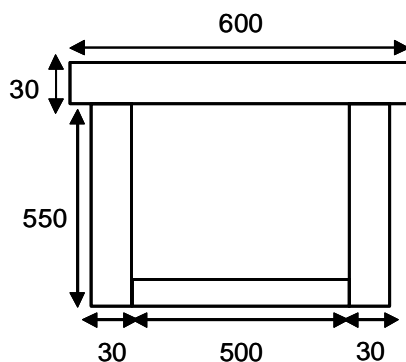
箱型断面図(アーチリブ両端の部材) 図-2.8 I型断面図(スパン中央部の吊材)
